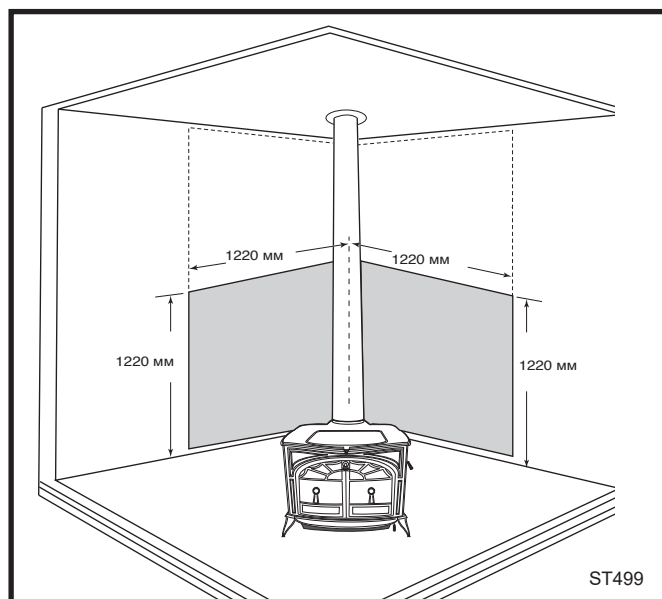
Угловая установка, вертикальная соединительная труба, два настенных экрана. Уменьшенные отступы с боков. Настенные экраны ДОЛЖНЫ стыковаться в углу.
